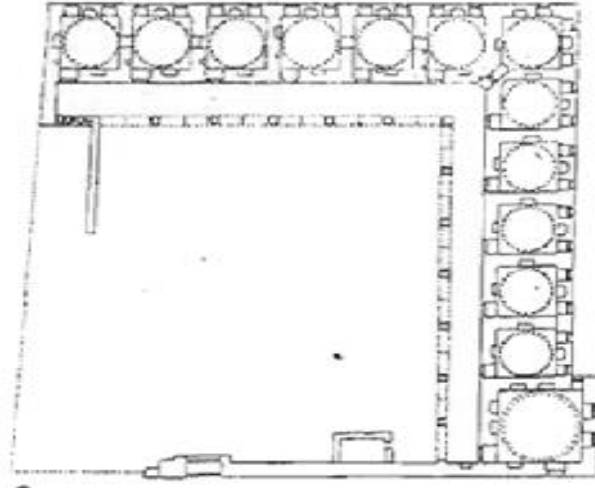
Karavezir Camii, Vaziyet Planı (V.G.M,2024).
